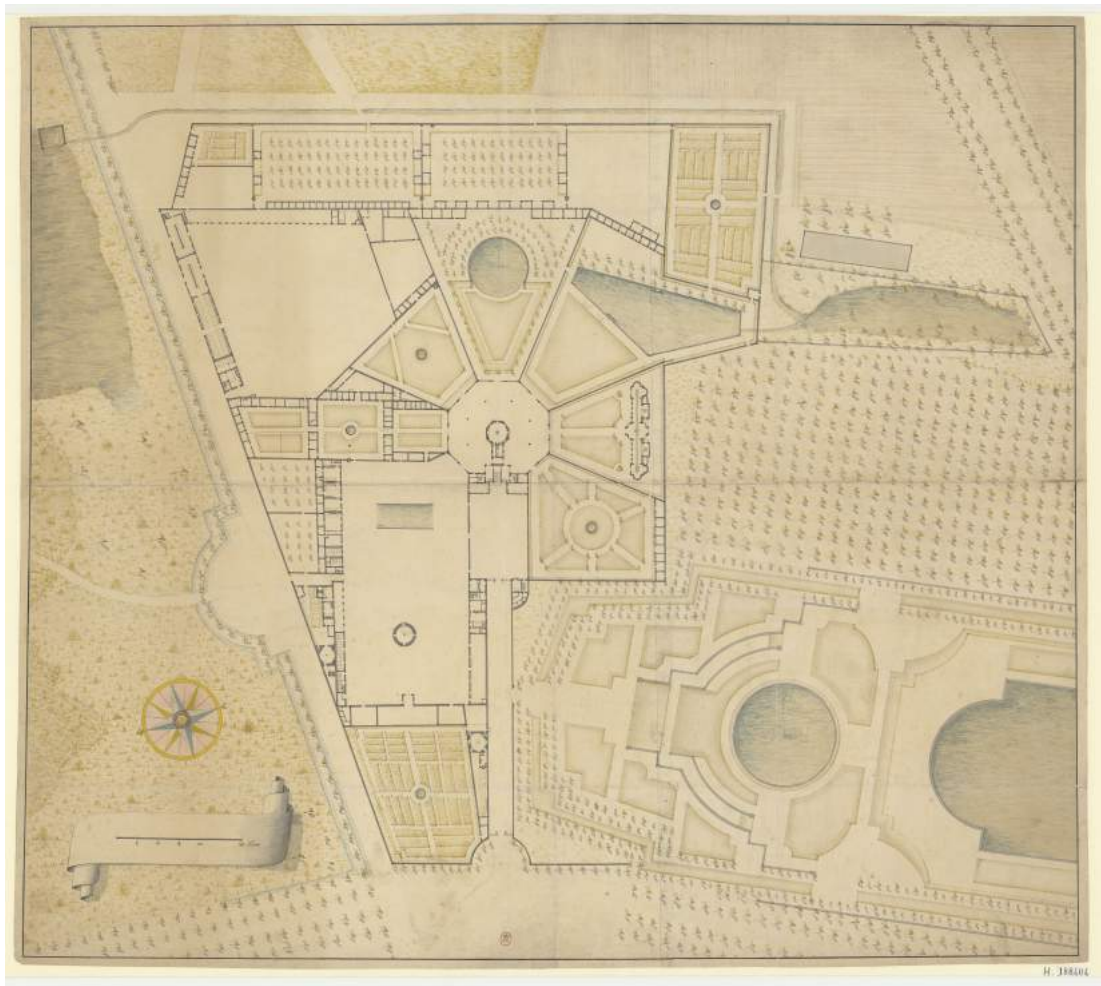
Plan de la Menagerie de Versailles [dessin, plan] - 1698
